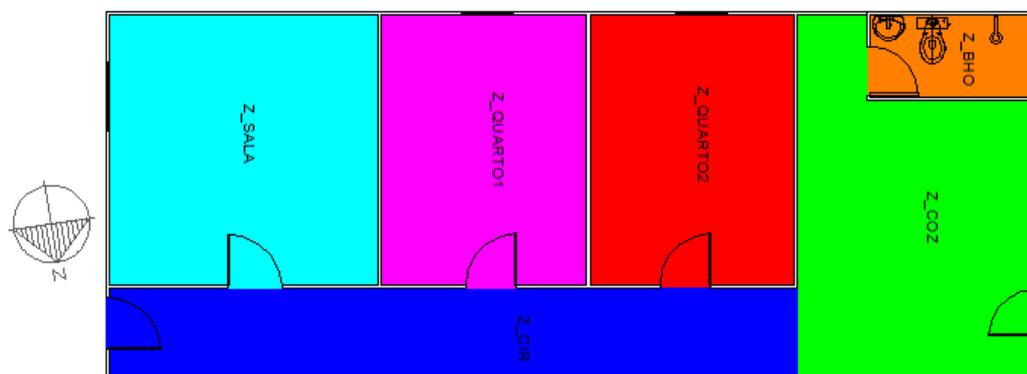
Planta baixa em zonas térmicas da tipologia palafita urbana leste
